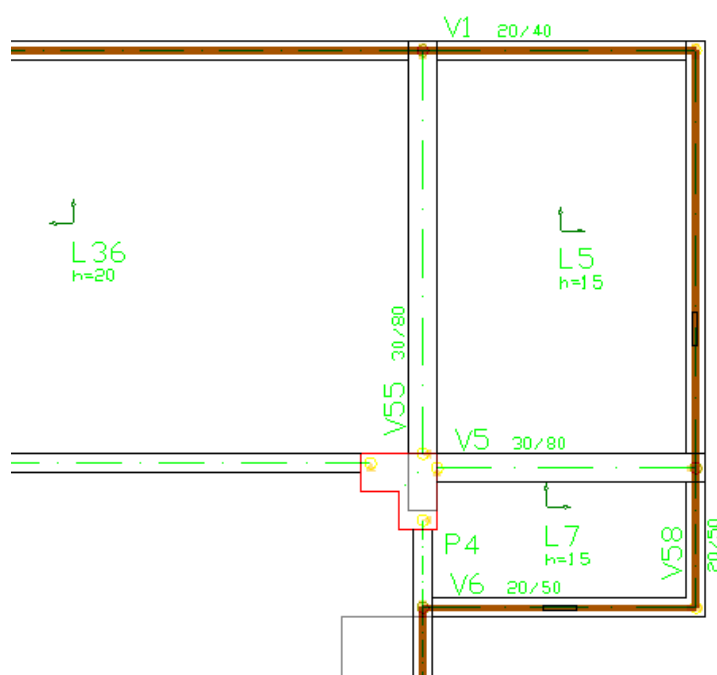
Pavimento Abrigo da Solução Convencional com as vigas V5 e V55 com maiores seções transversais
